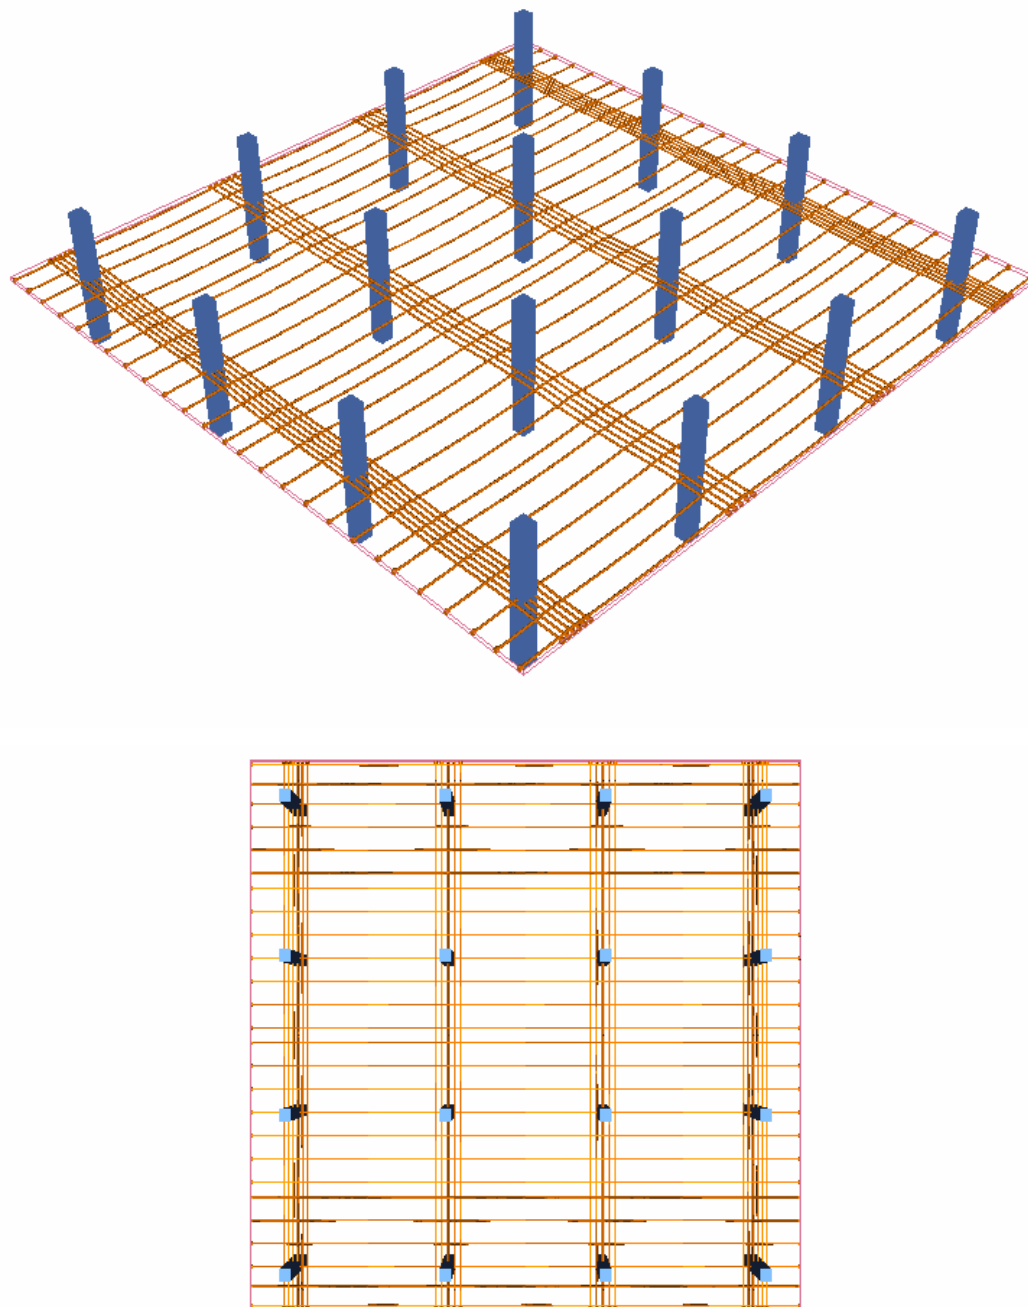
Cabos em Vista Tridimensional e em Planta
